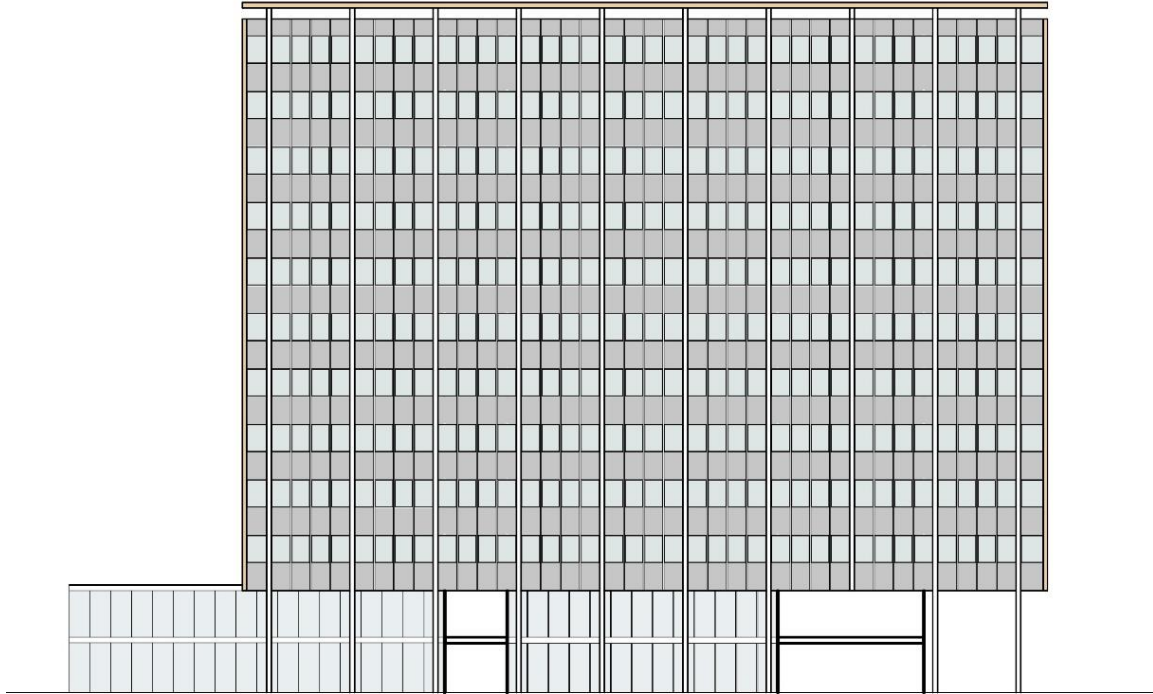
Fachada Oeste. Fuente: ETSEIB.
